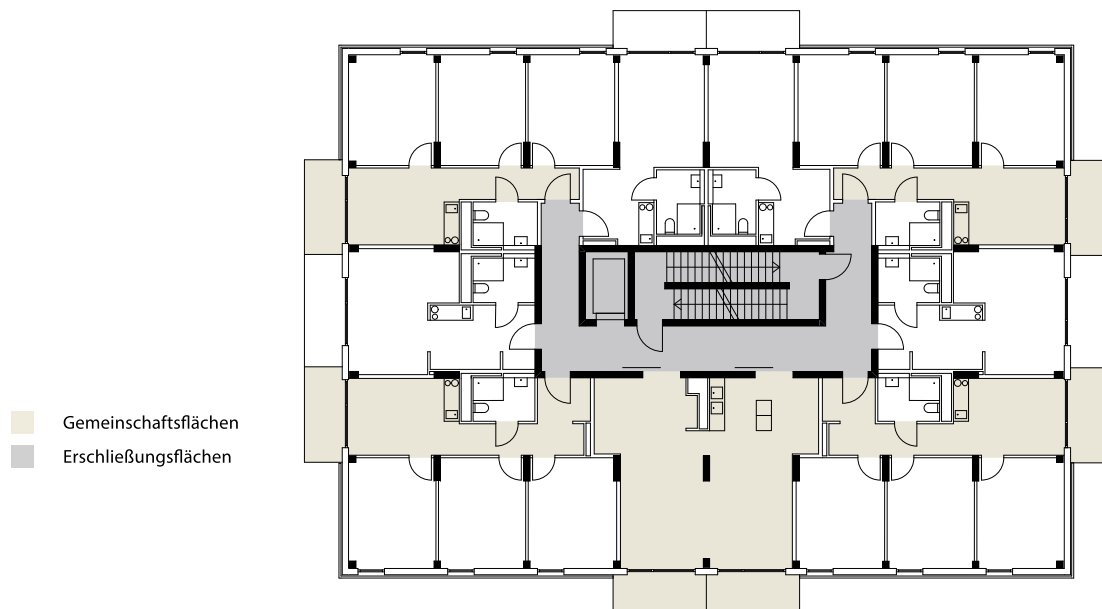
Grundriss Regelgeschoss mit innenliegendem Doppelhelix-Treppenhaus, M. 1:300 [© BF Vario]
